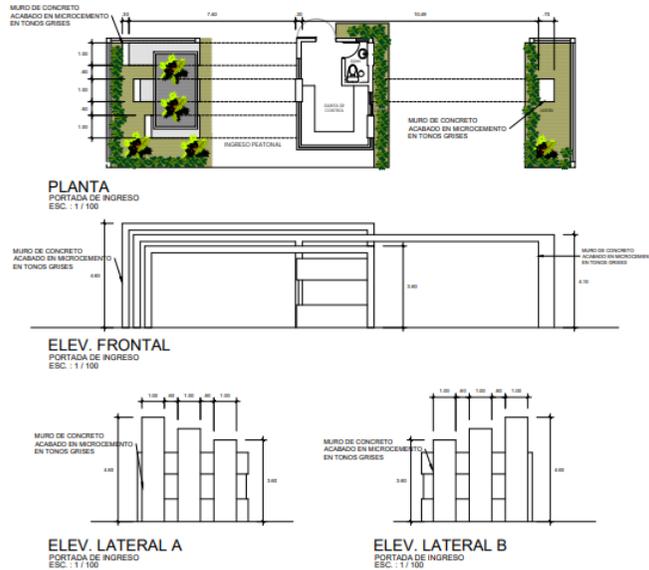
Detalle de pórtico de ingreso, Autoría propia.
